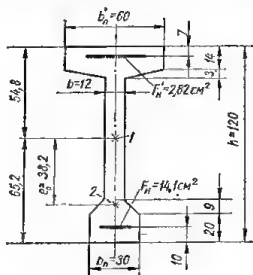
Схема поперечного сечения предварительно напряженной железобетонной балки:
